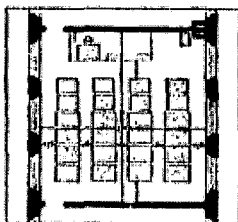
Plan d'une classe à éclairage bilatéral.
